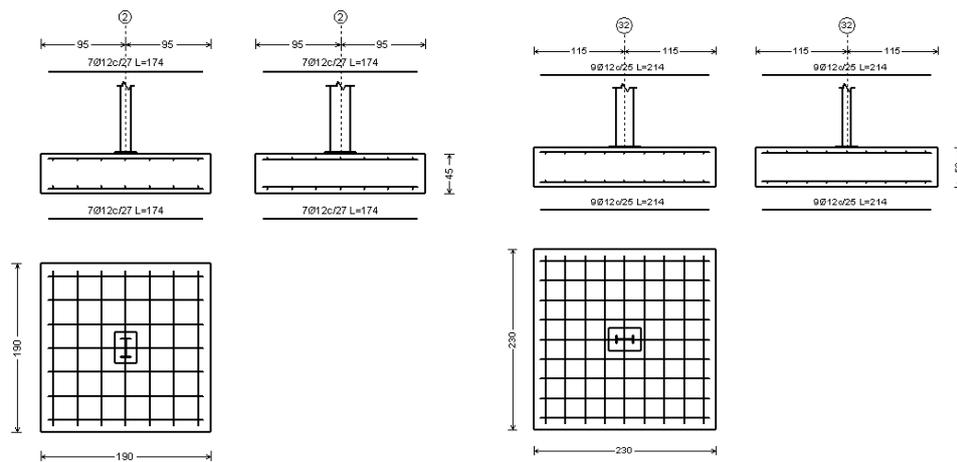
Vista zapatas cuadradas (Fuente: CypeCad)
